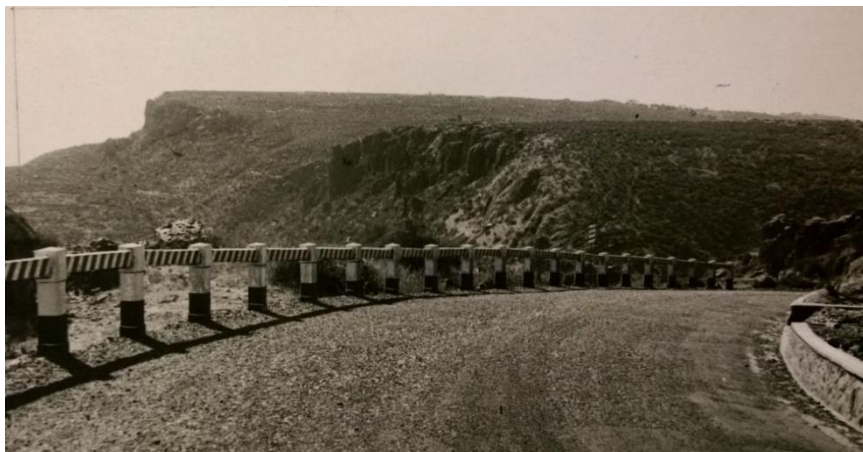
(ATCI) di un tratto delle strade imperiali costruite nel sud dell'Eritrea subito dopo la conquista dell'Etiopia. È possibile osservare i montanti di sostegno alle barriere a bordo strada, che costituivano un sistema di protezione ampiamente utilizzato lungo la Massaua-Asmara.
